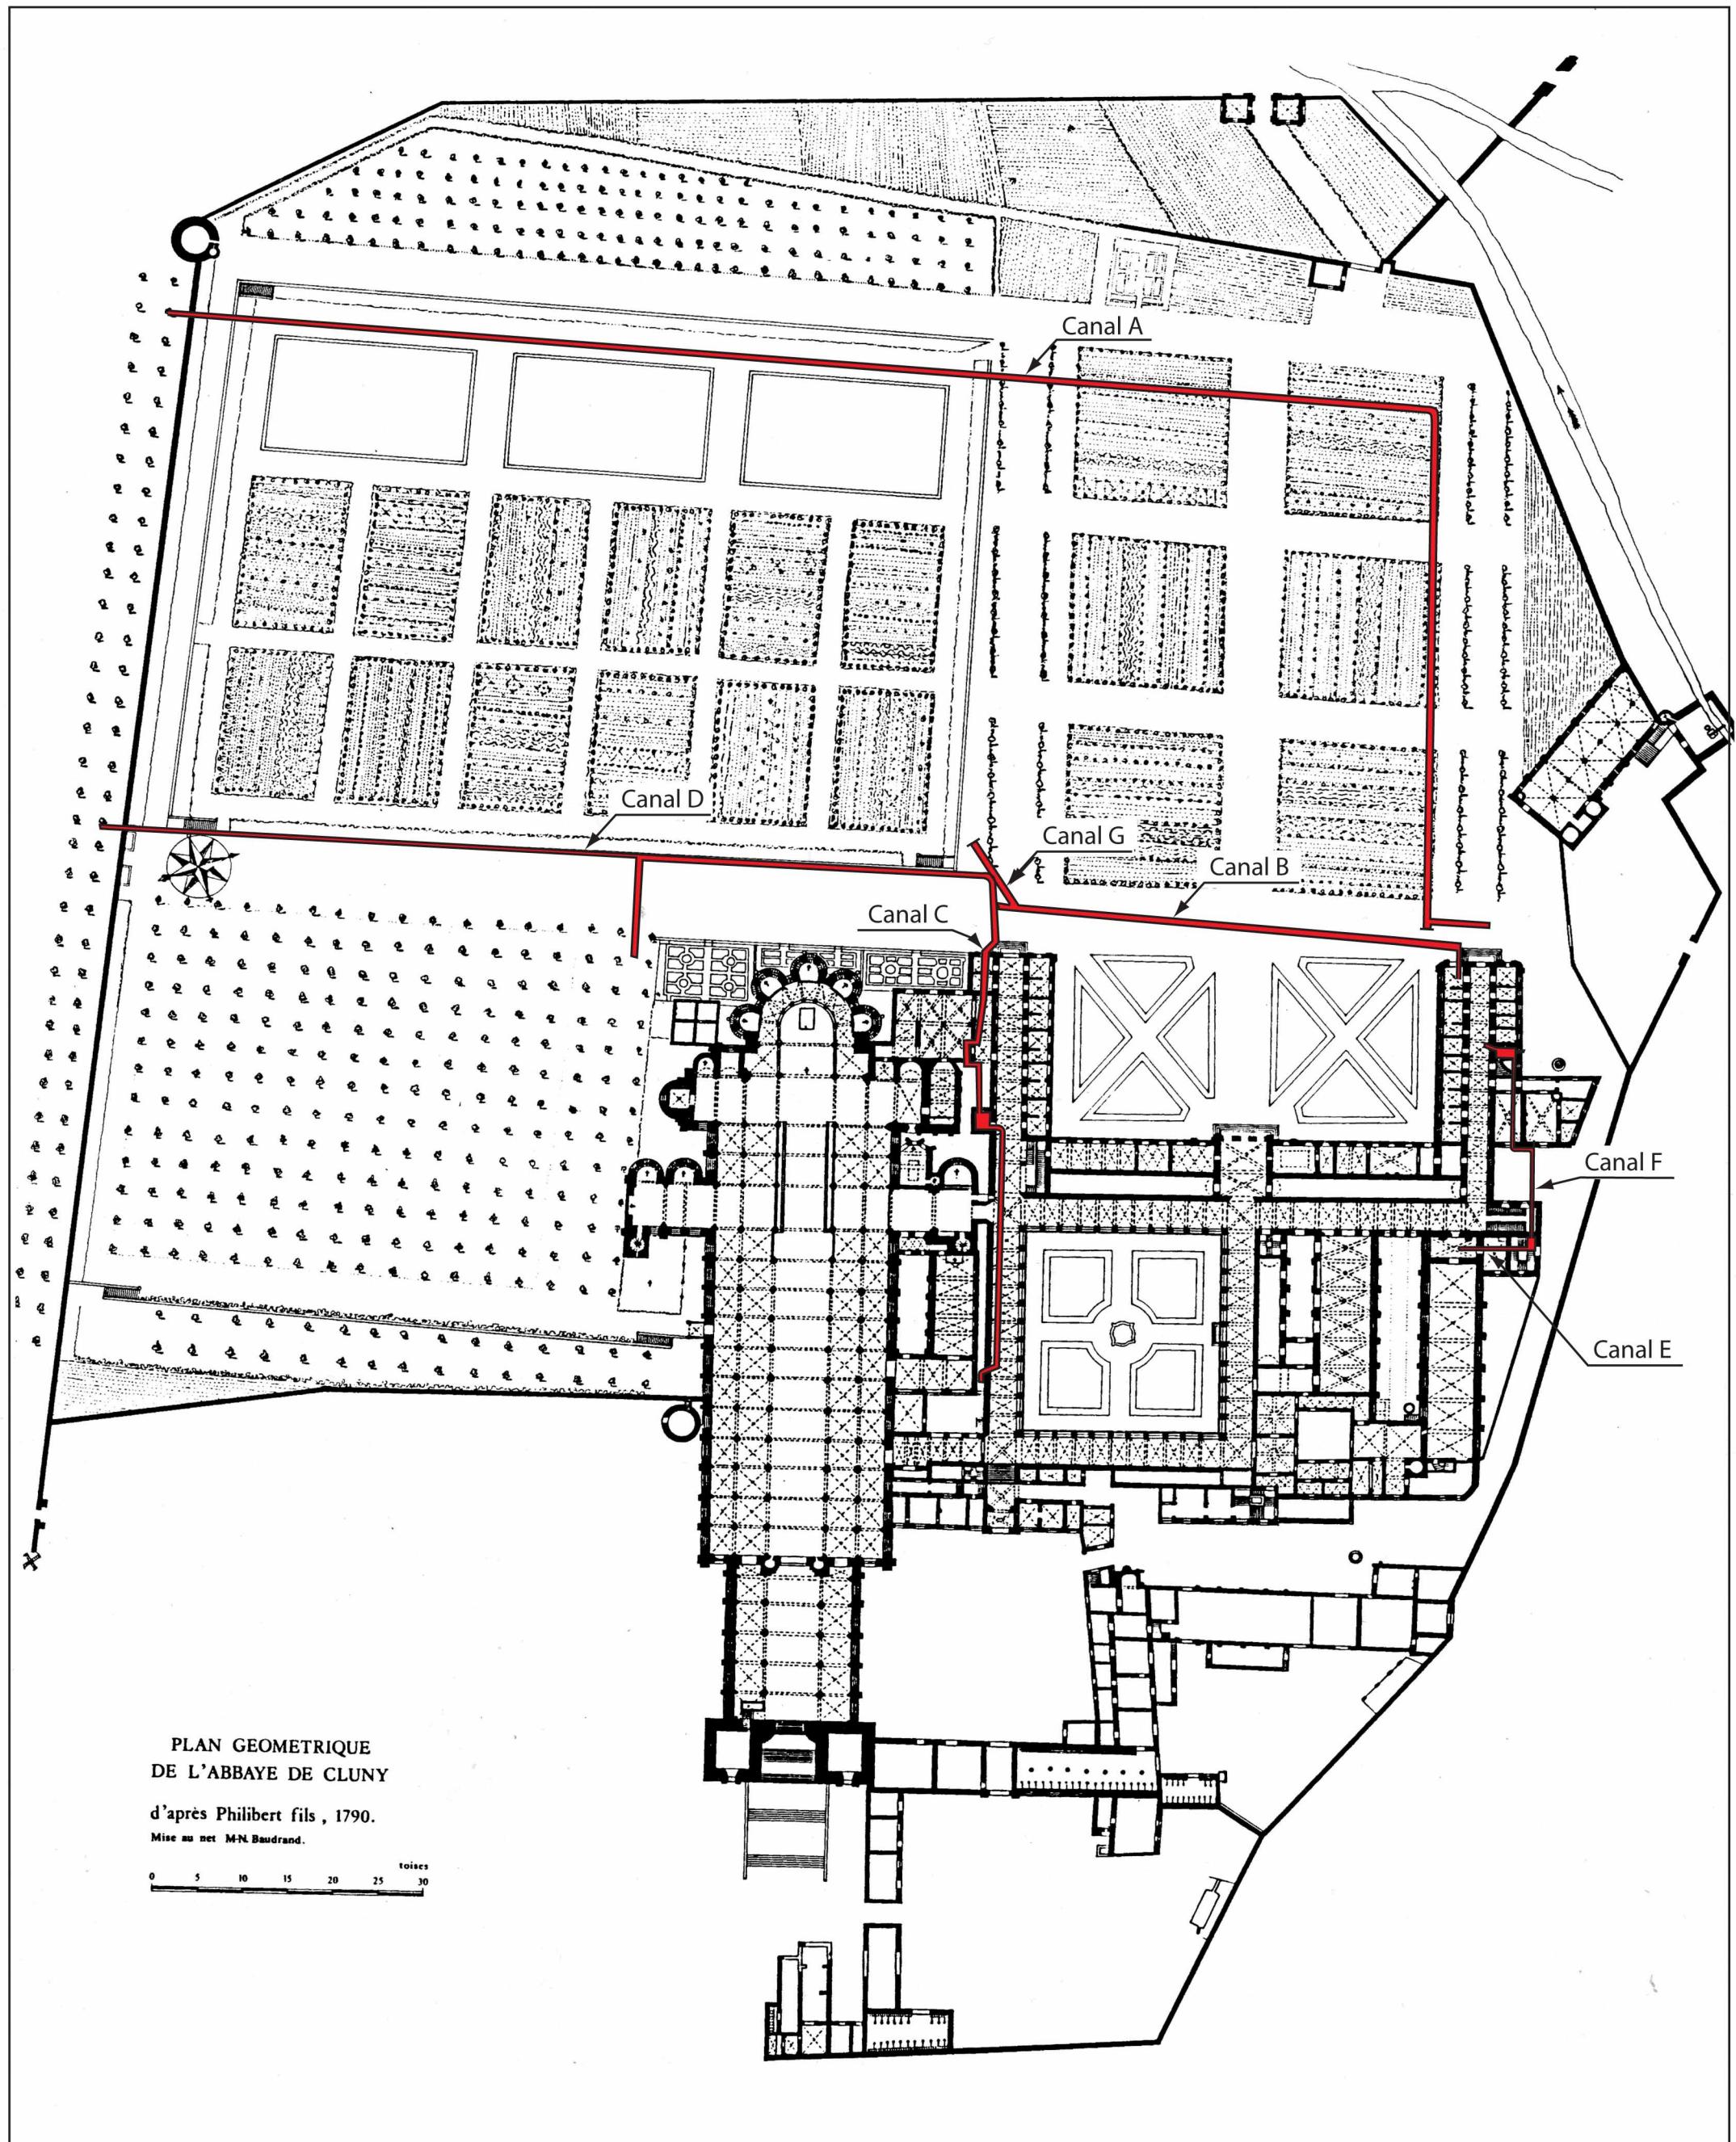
Réseau d'assainissement de l'abbaye en correspondance avec le plan Philibert de 1790.
